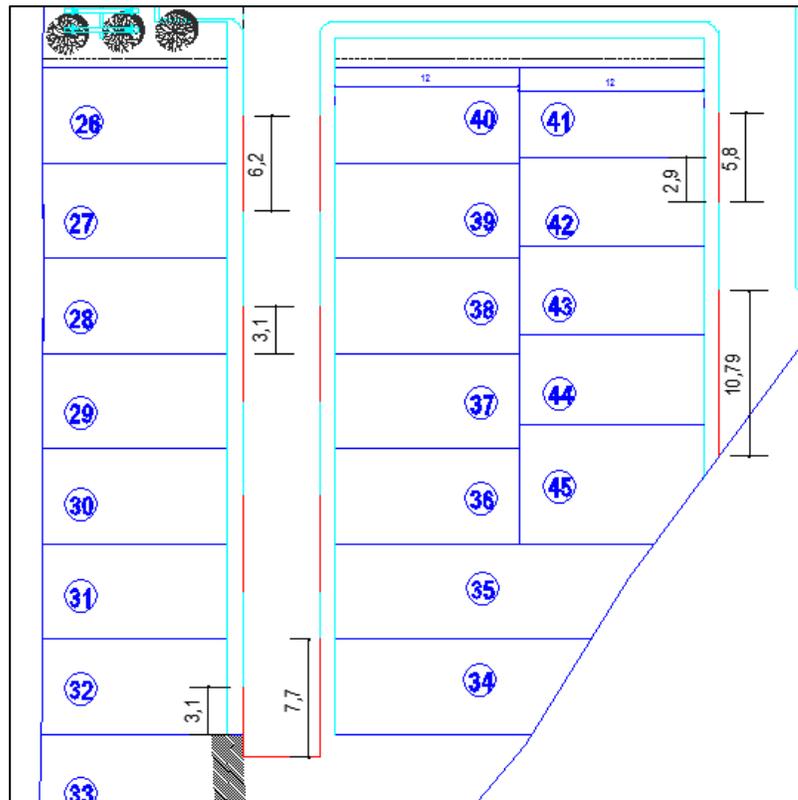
Dibujo en planta de zonas bajas y altas sobre los lotes. Fuente: Propia.
